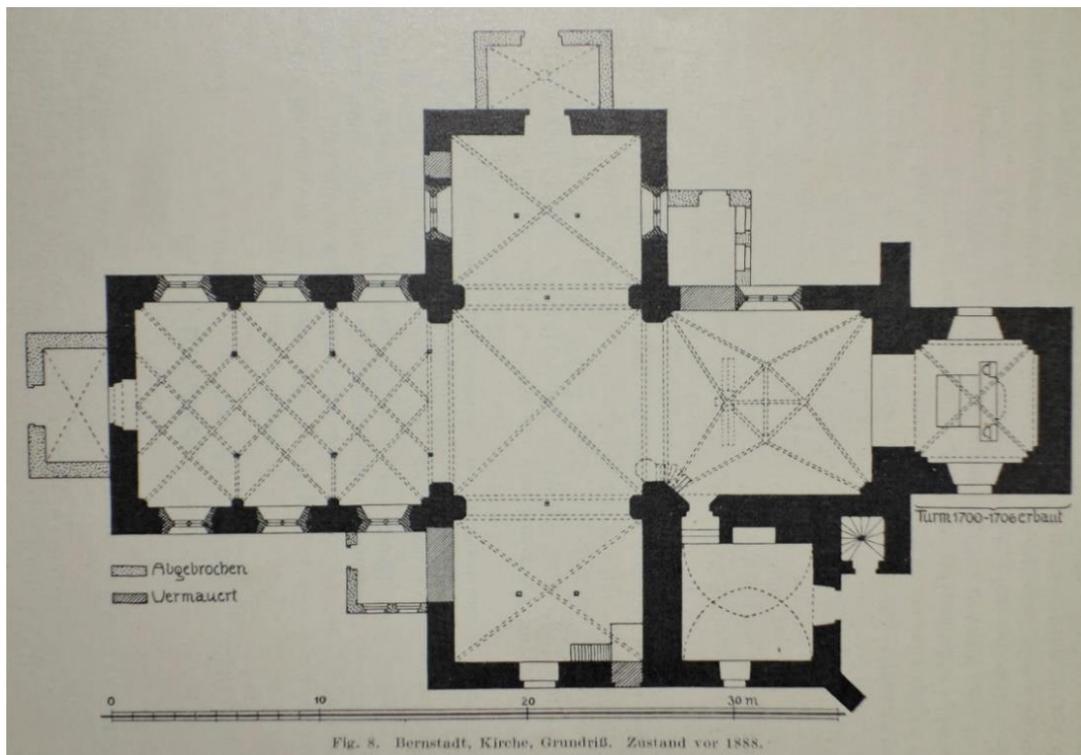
Grundrissplan vor dem Umbau 1888⁸
